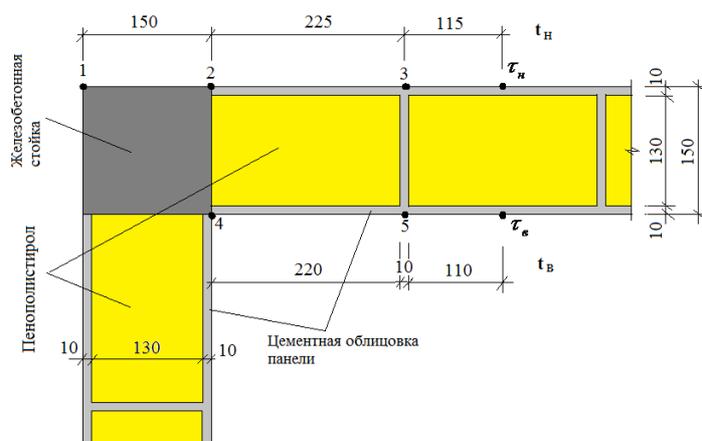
Конструктивное решение и расчетная схема угла наружной стены из сэндвич-панелей с угловой железобетонной стойкой без утепления для расчета температурного поля: 1...5 - расчетные точки.
